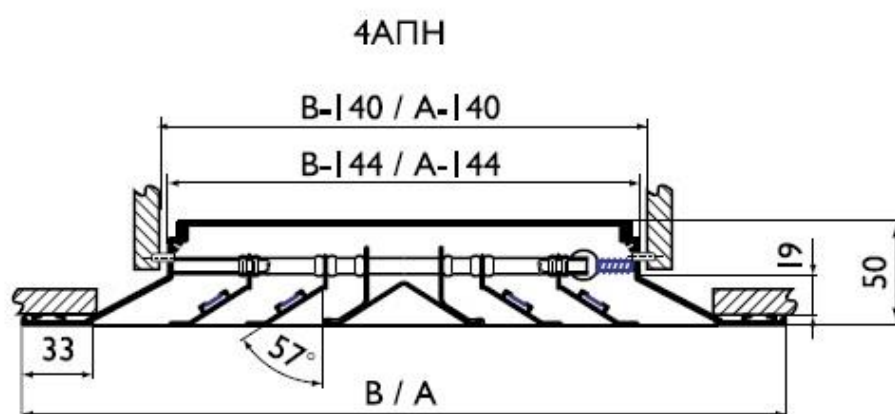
Конструктивная схема воздухораспределителя 4АПН
